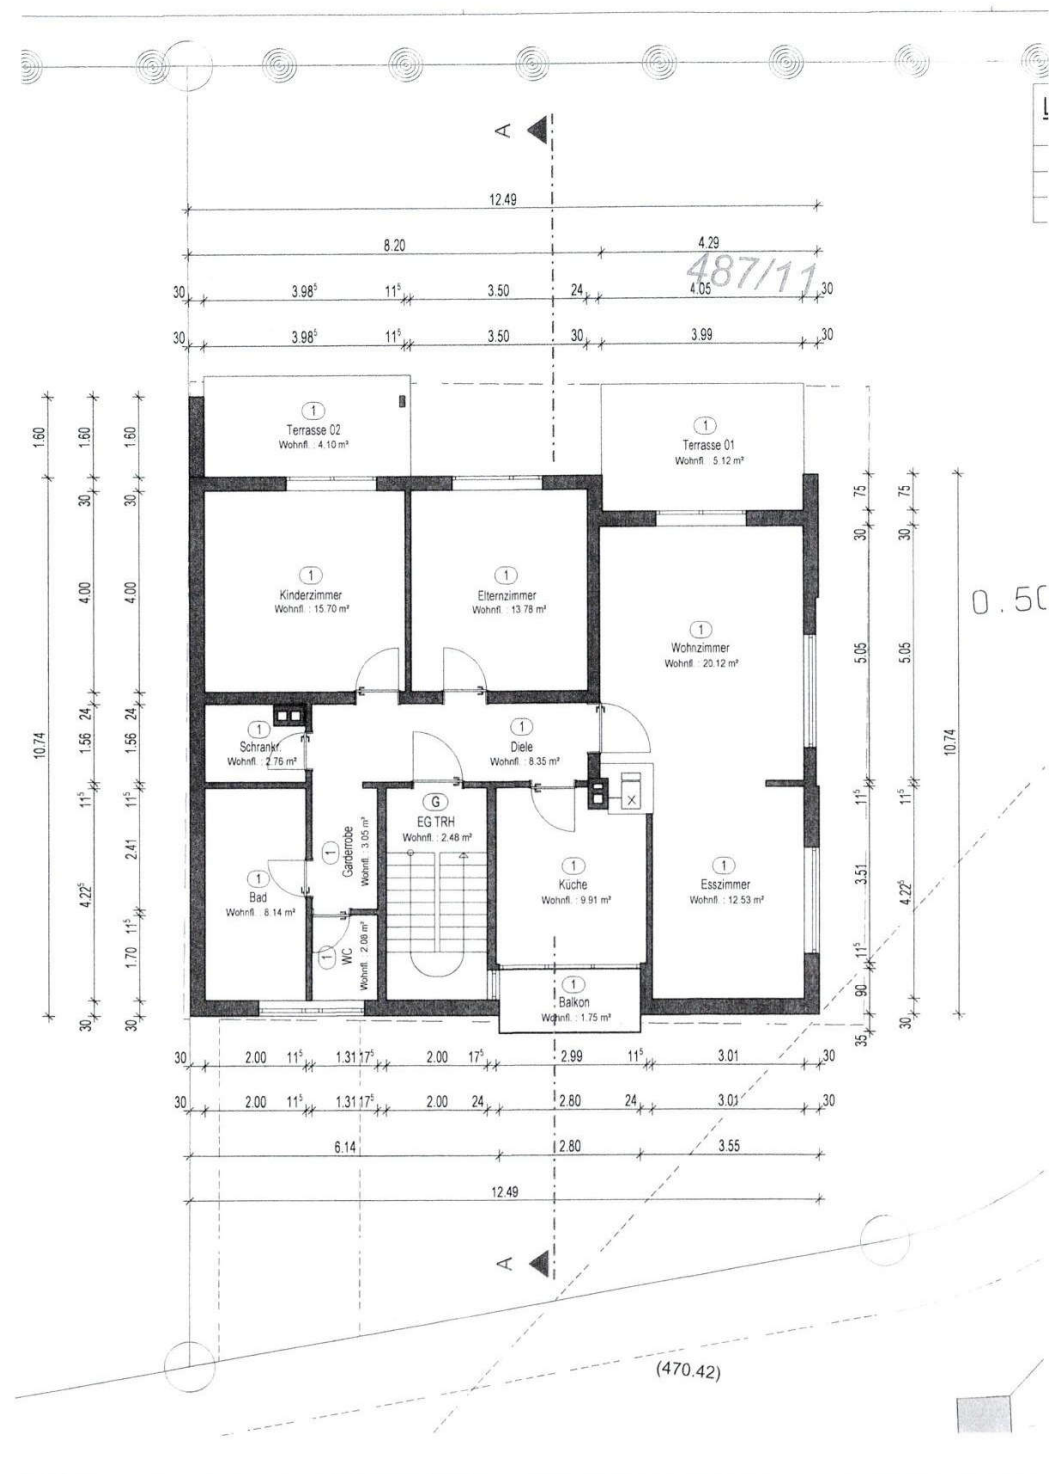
Zeichnungen nach Aufteilungsplan (Teilung wurde nicht vollzogen); hier EG
